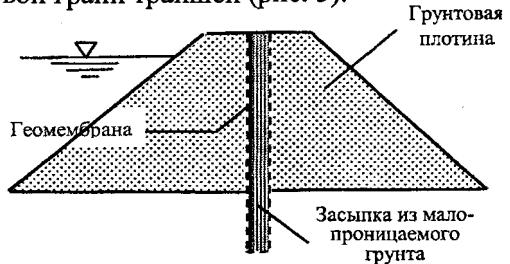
Гидроизоляция грунтовой плотины с помощью геомембранны
